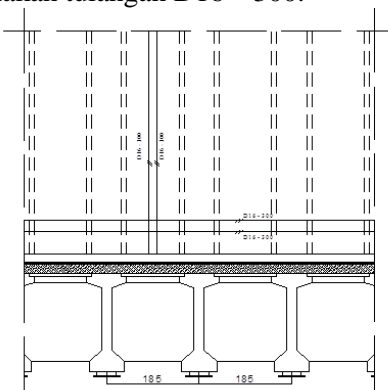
Potongan Melintang Bangunan Atas Jembatan
